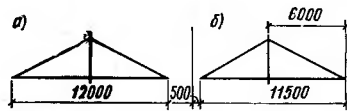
Схемы подстропильных ферм пролетом 12 м
